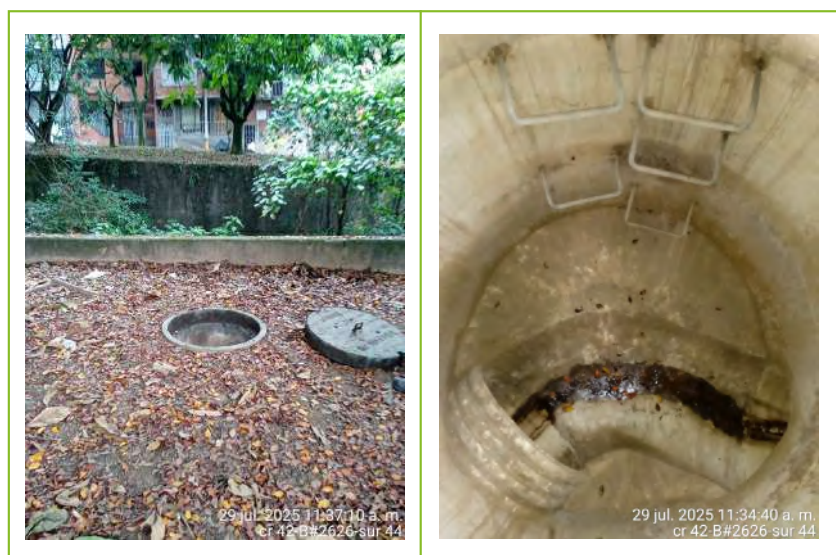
Construcción de MH D=1.5 m para la instalación de válvula pico de pato, descarga aguas lluvias Quebrada La Ayurá, Carrera 42 con la calle 26 Sur, Envigado.
